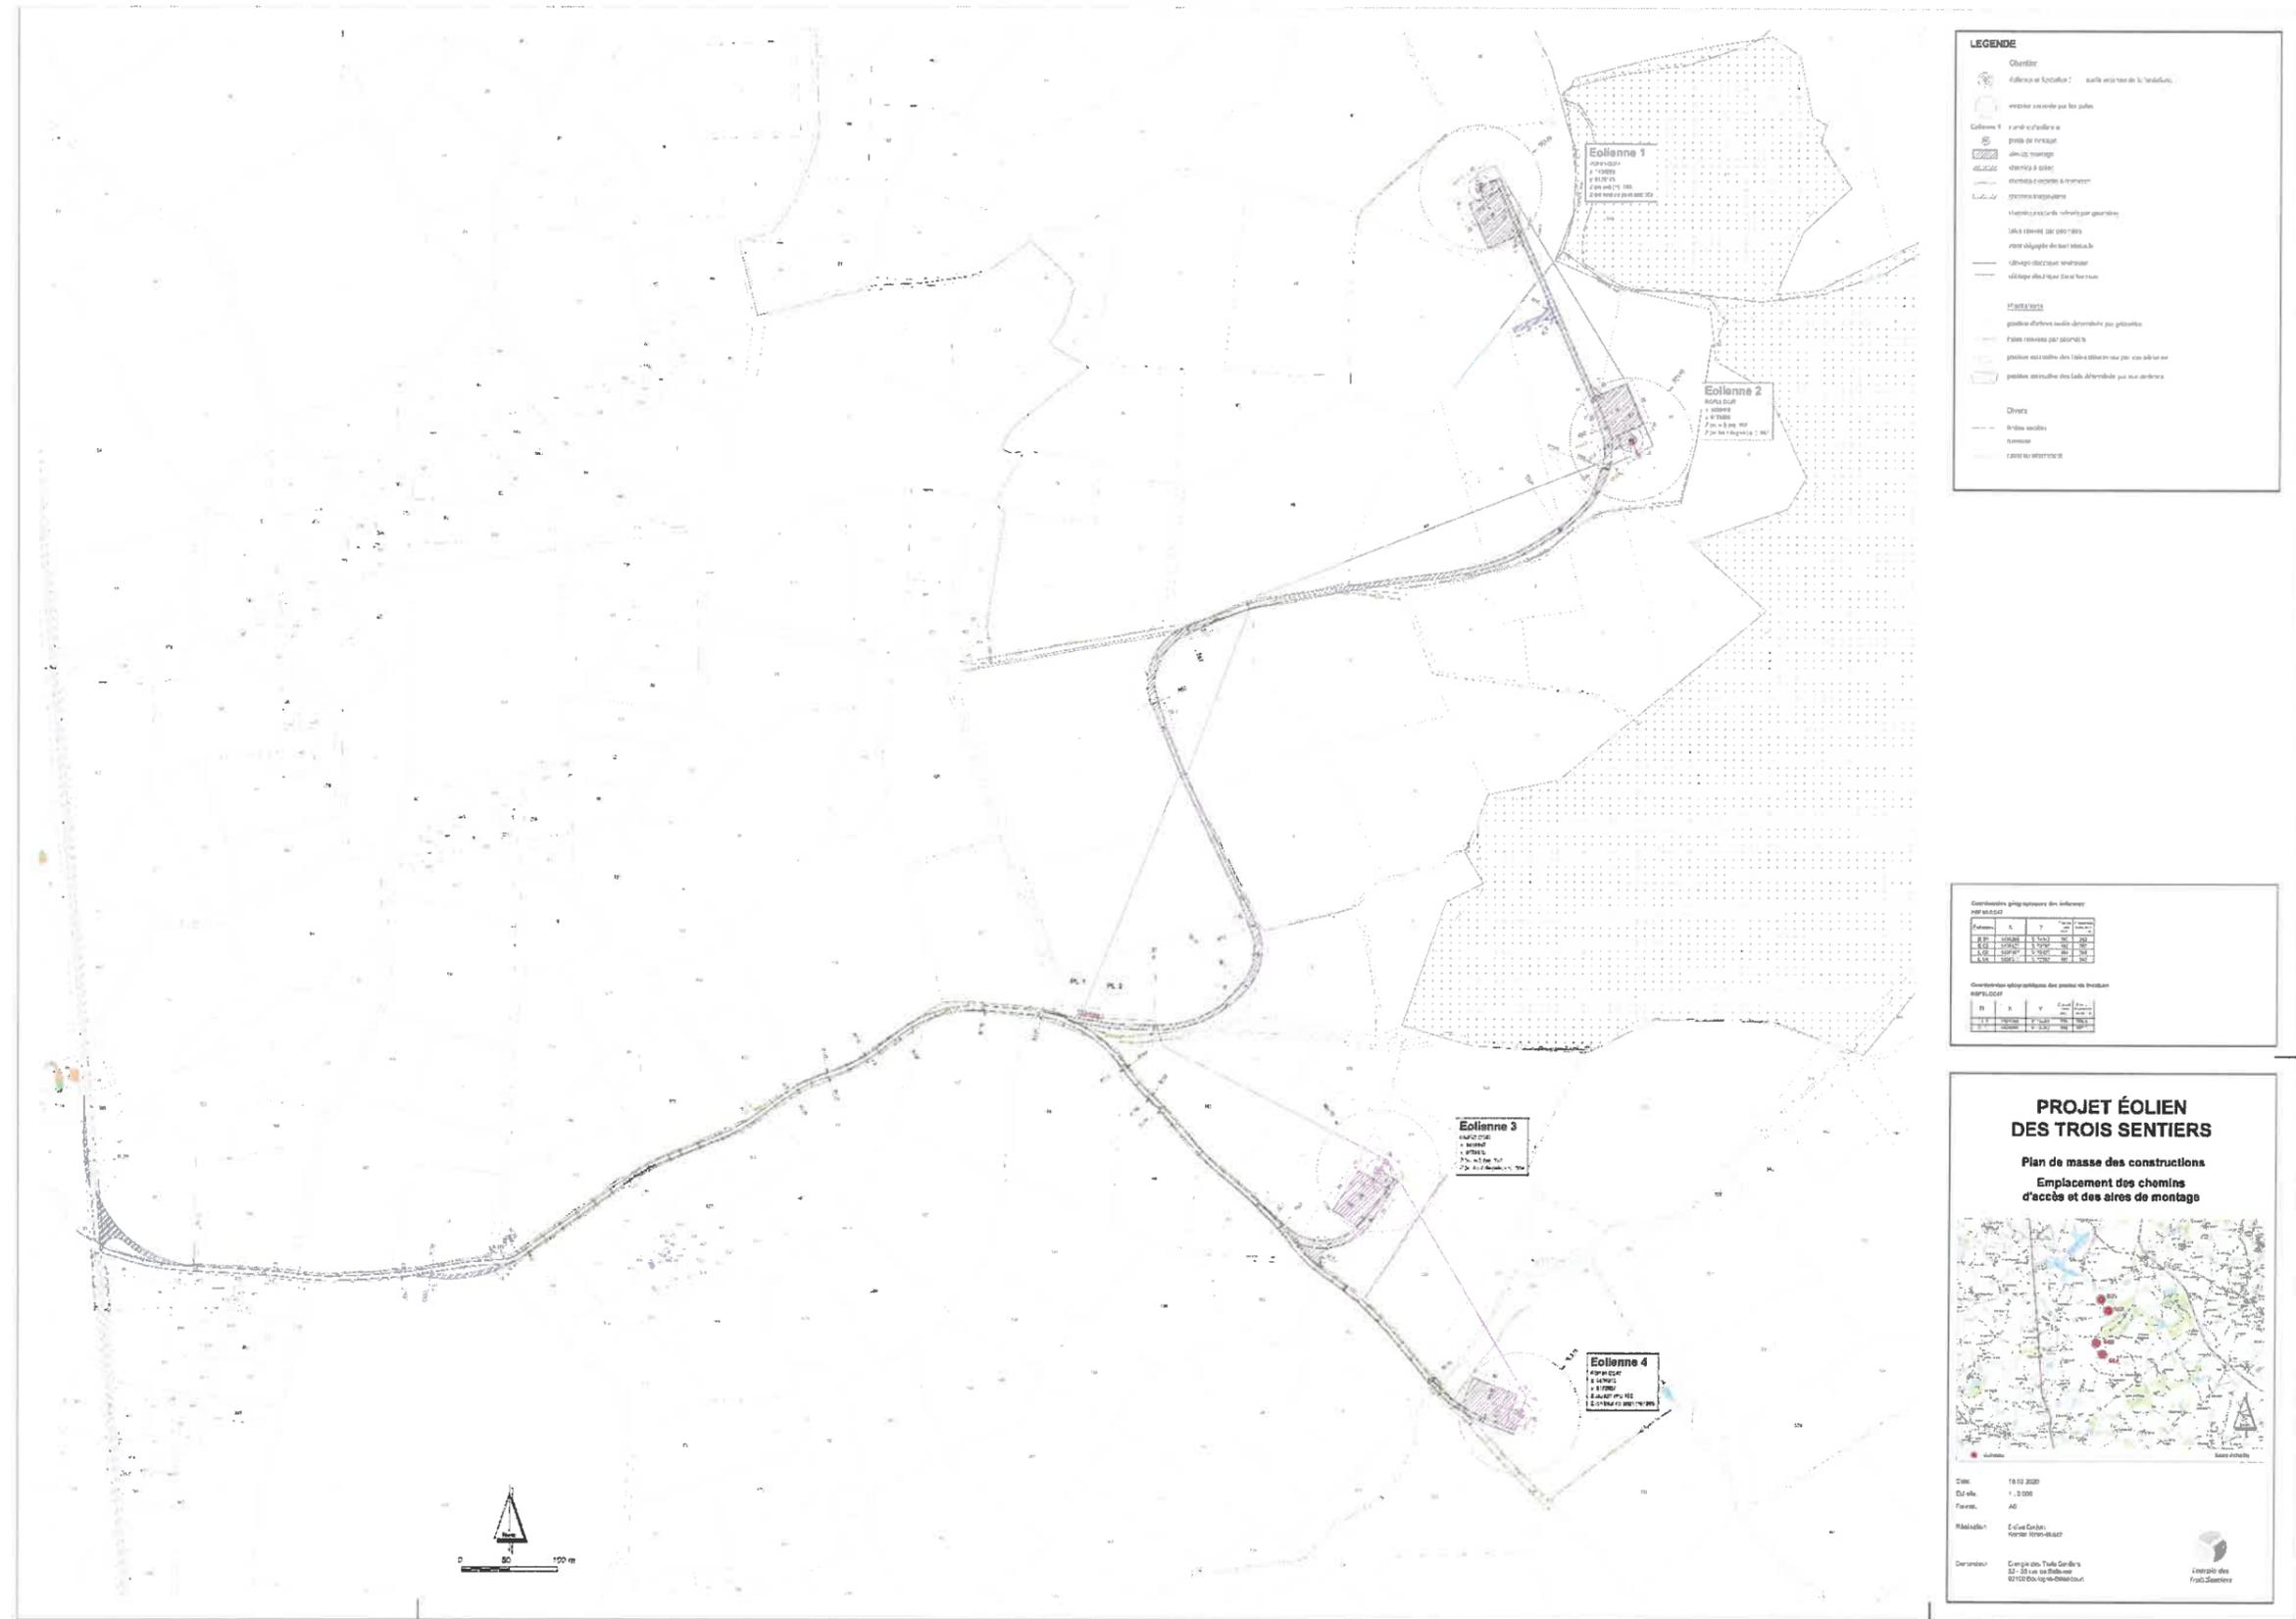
Plan de masse du projet de Parc éolien des Trois Sentiers
